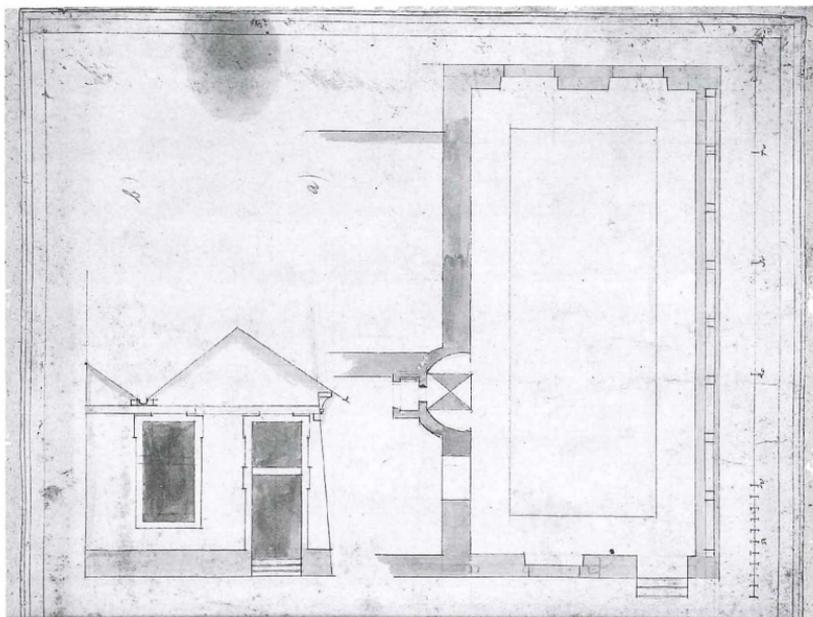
Grundriss und Westansicht des umgebauten Petersbrunner Glashauses
